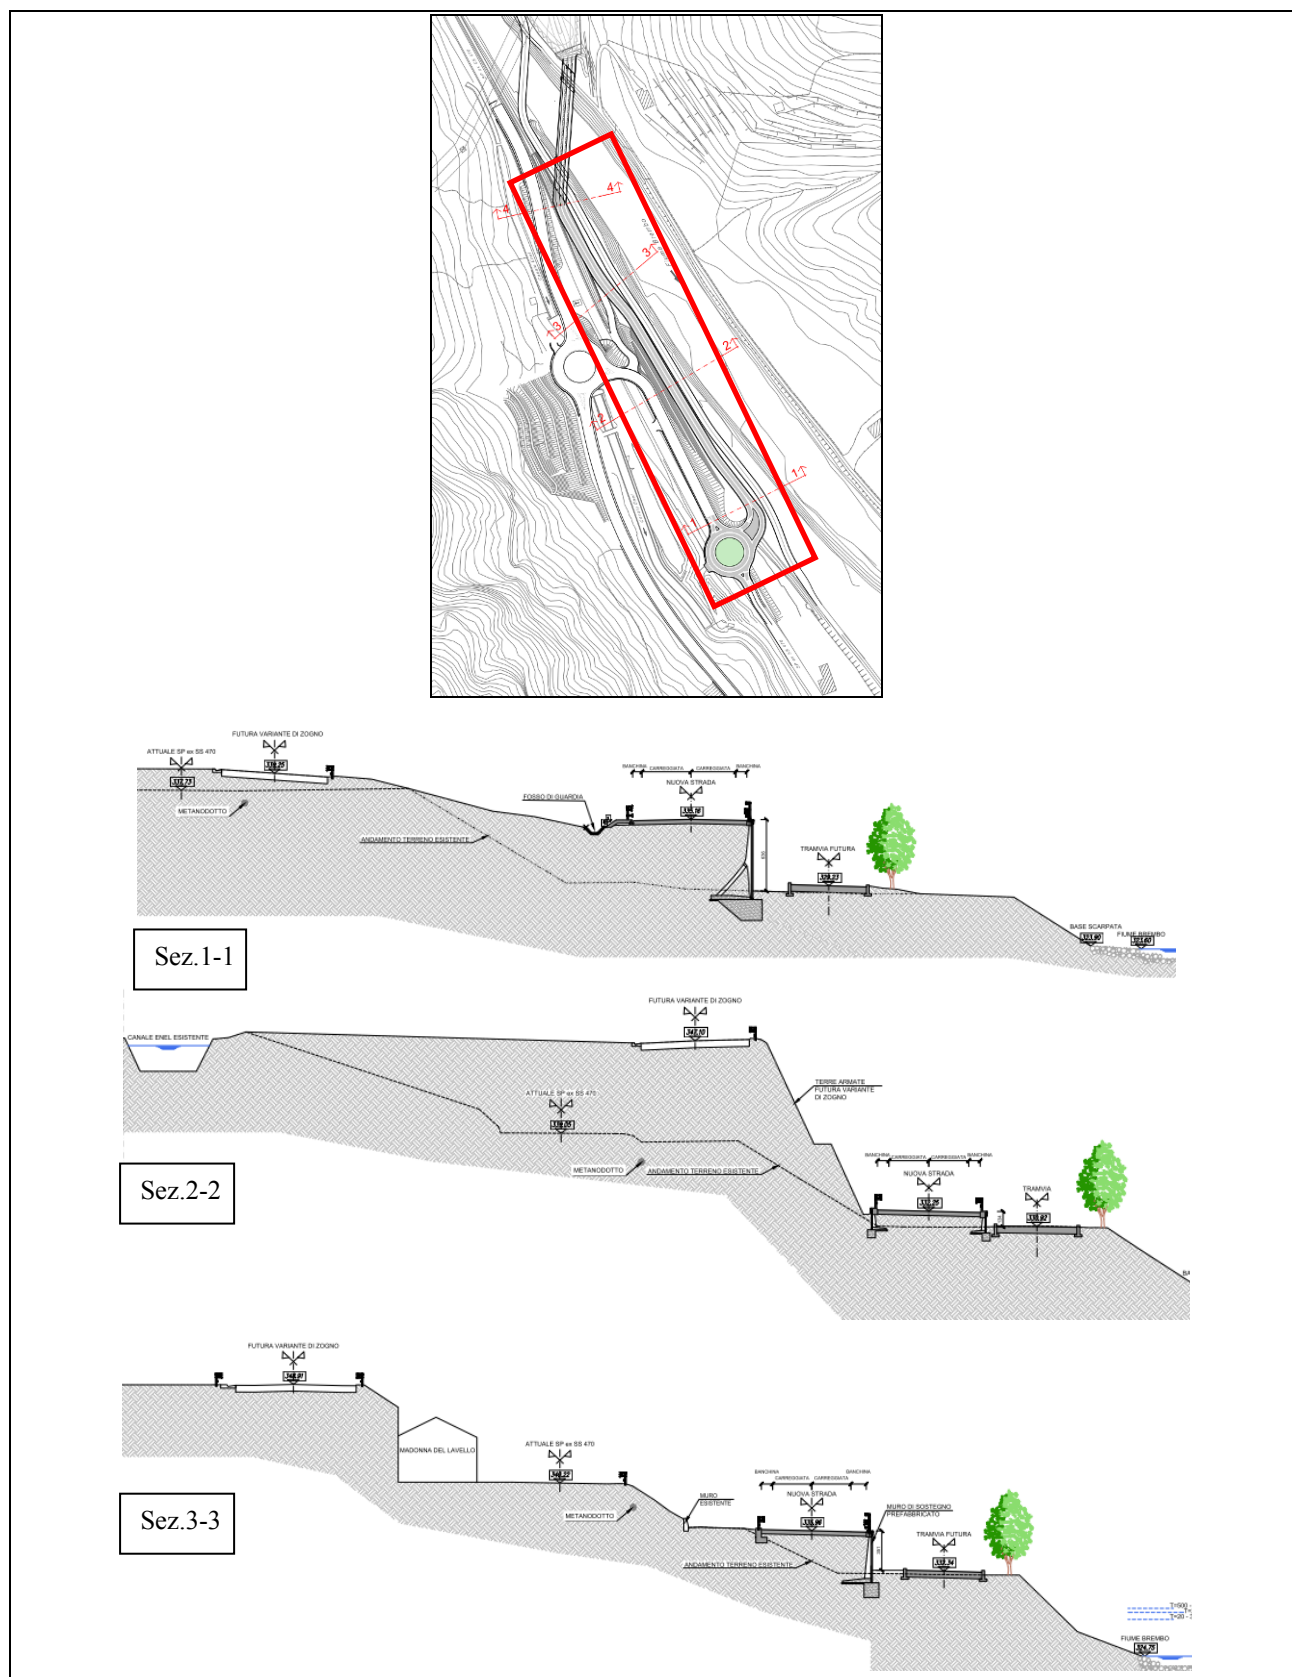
Planimetria di progetto con tre sezioni indicative delle caratteristiche del nuovo intervento
